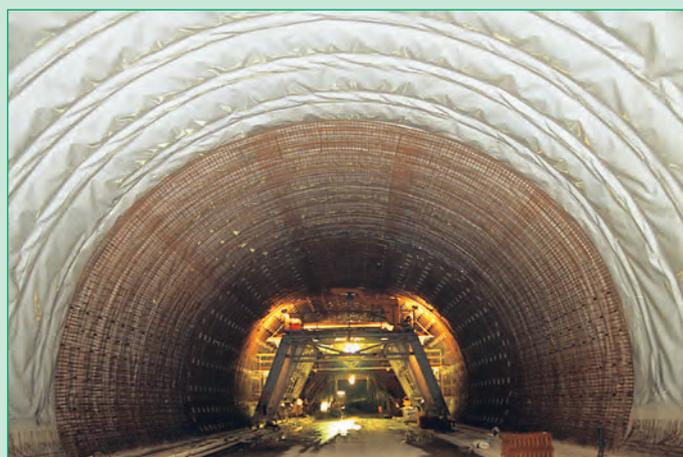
Instalación de geomembrana de túnel Carbofol® entre el refuerzo de concreto, el muro interior y el concreto lanzado
